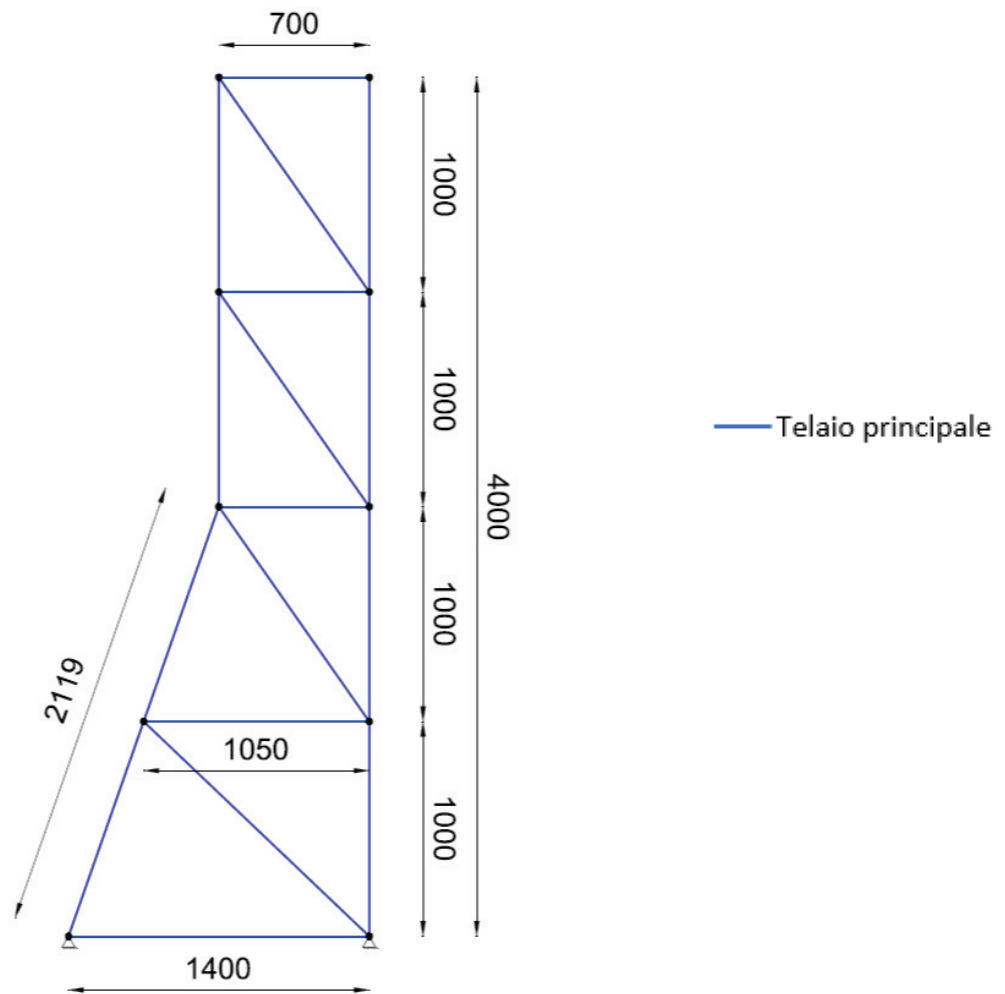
Scheletro strutturale telaio principale (unità di misura "mm")
